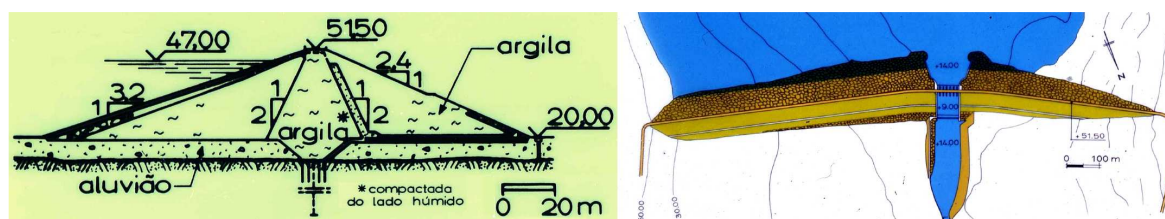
Perfil transversal tipo e planta da barragem dos Pequenos Libombos
